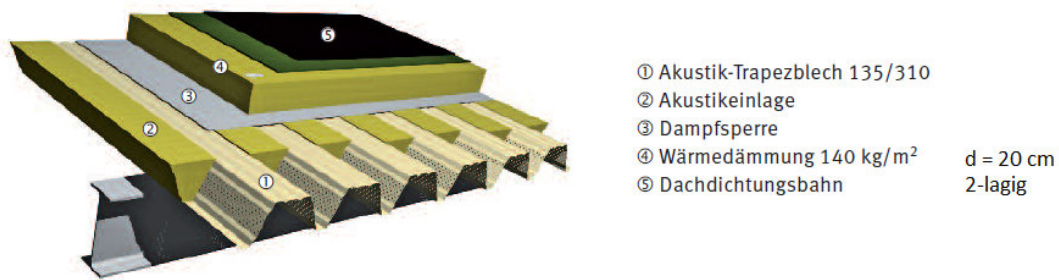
Schichtweiser Dachaufbau [52]
